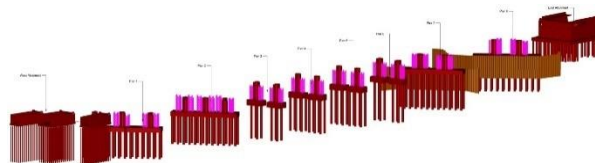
Fase de construcción – Colocación de apoyos temporales.
